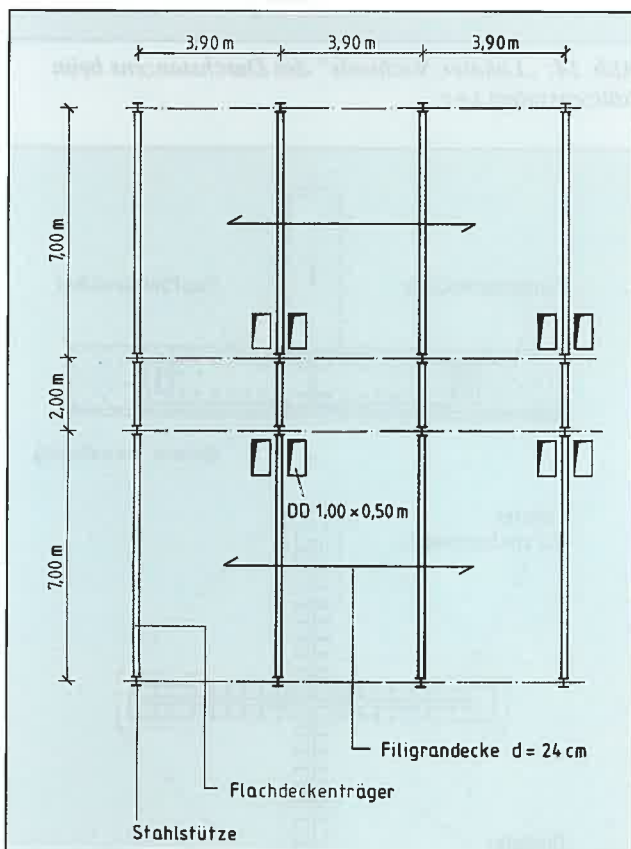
Hotelbau Berlin (Entwurf: ARC Factory, Dipl.-Ing. Voissel, Berlin): Stützenraster mit Deckendurchbrüchen
